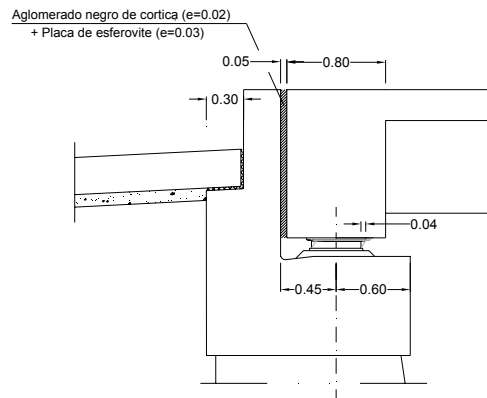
Pormenor da zona de apoio no Encontro E1 da PI12B1
